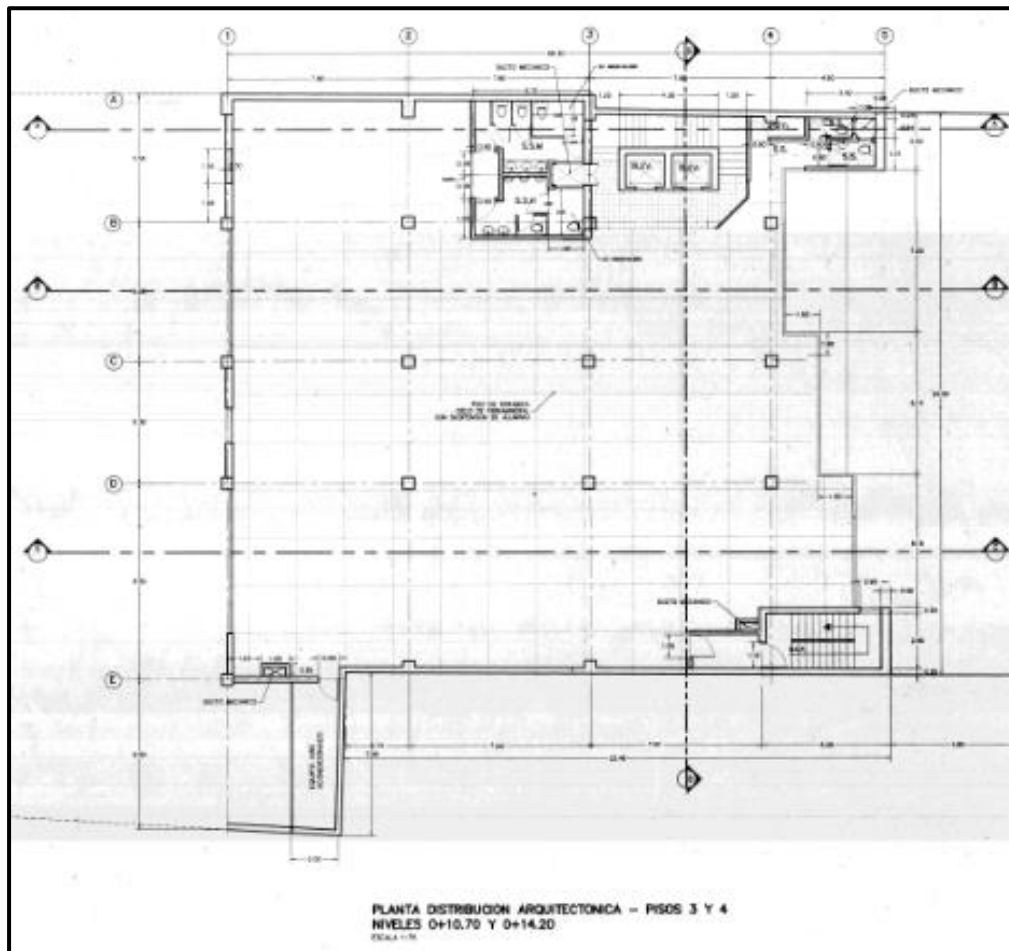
Planta de áreas de pisos 1-2-3- 4-5-6.
